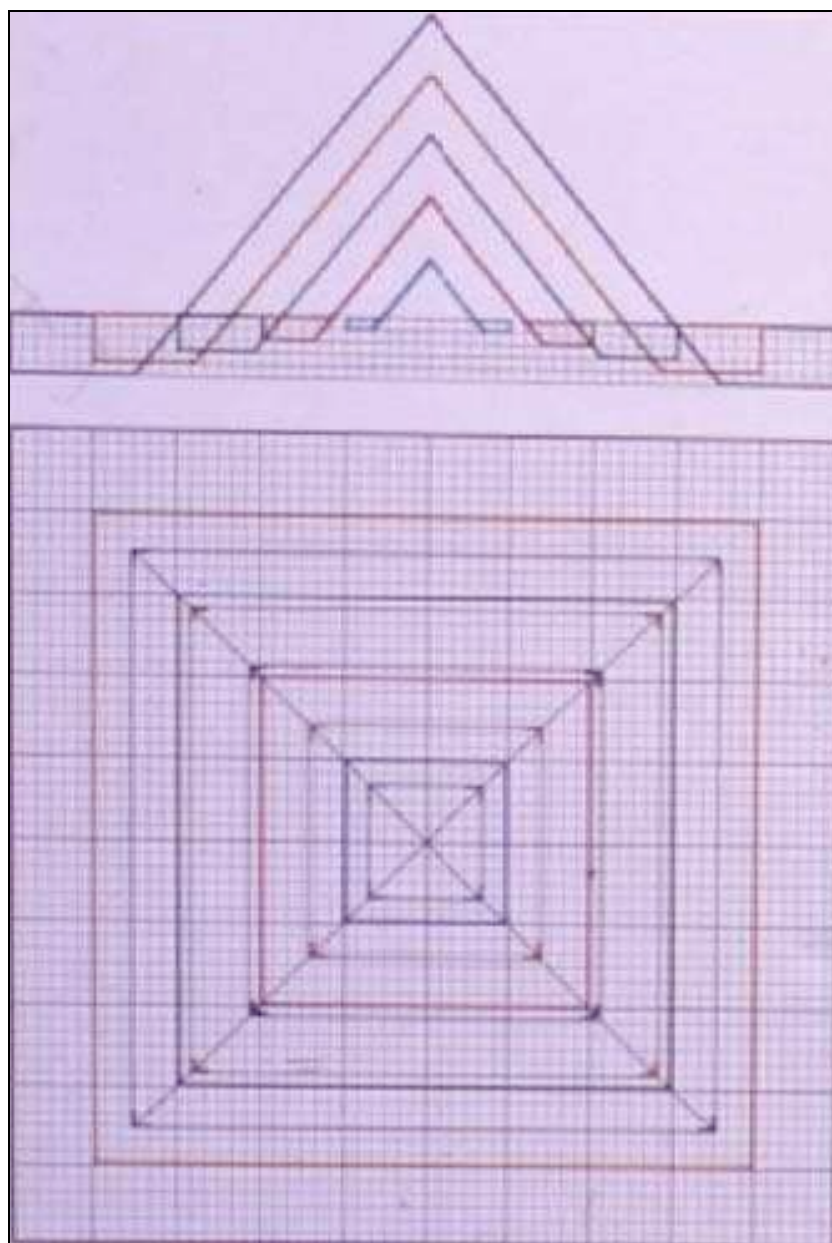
Cas où la carrière a une surface double de celle de la pyramide
